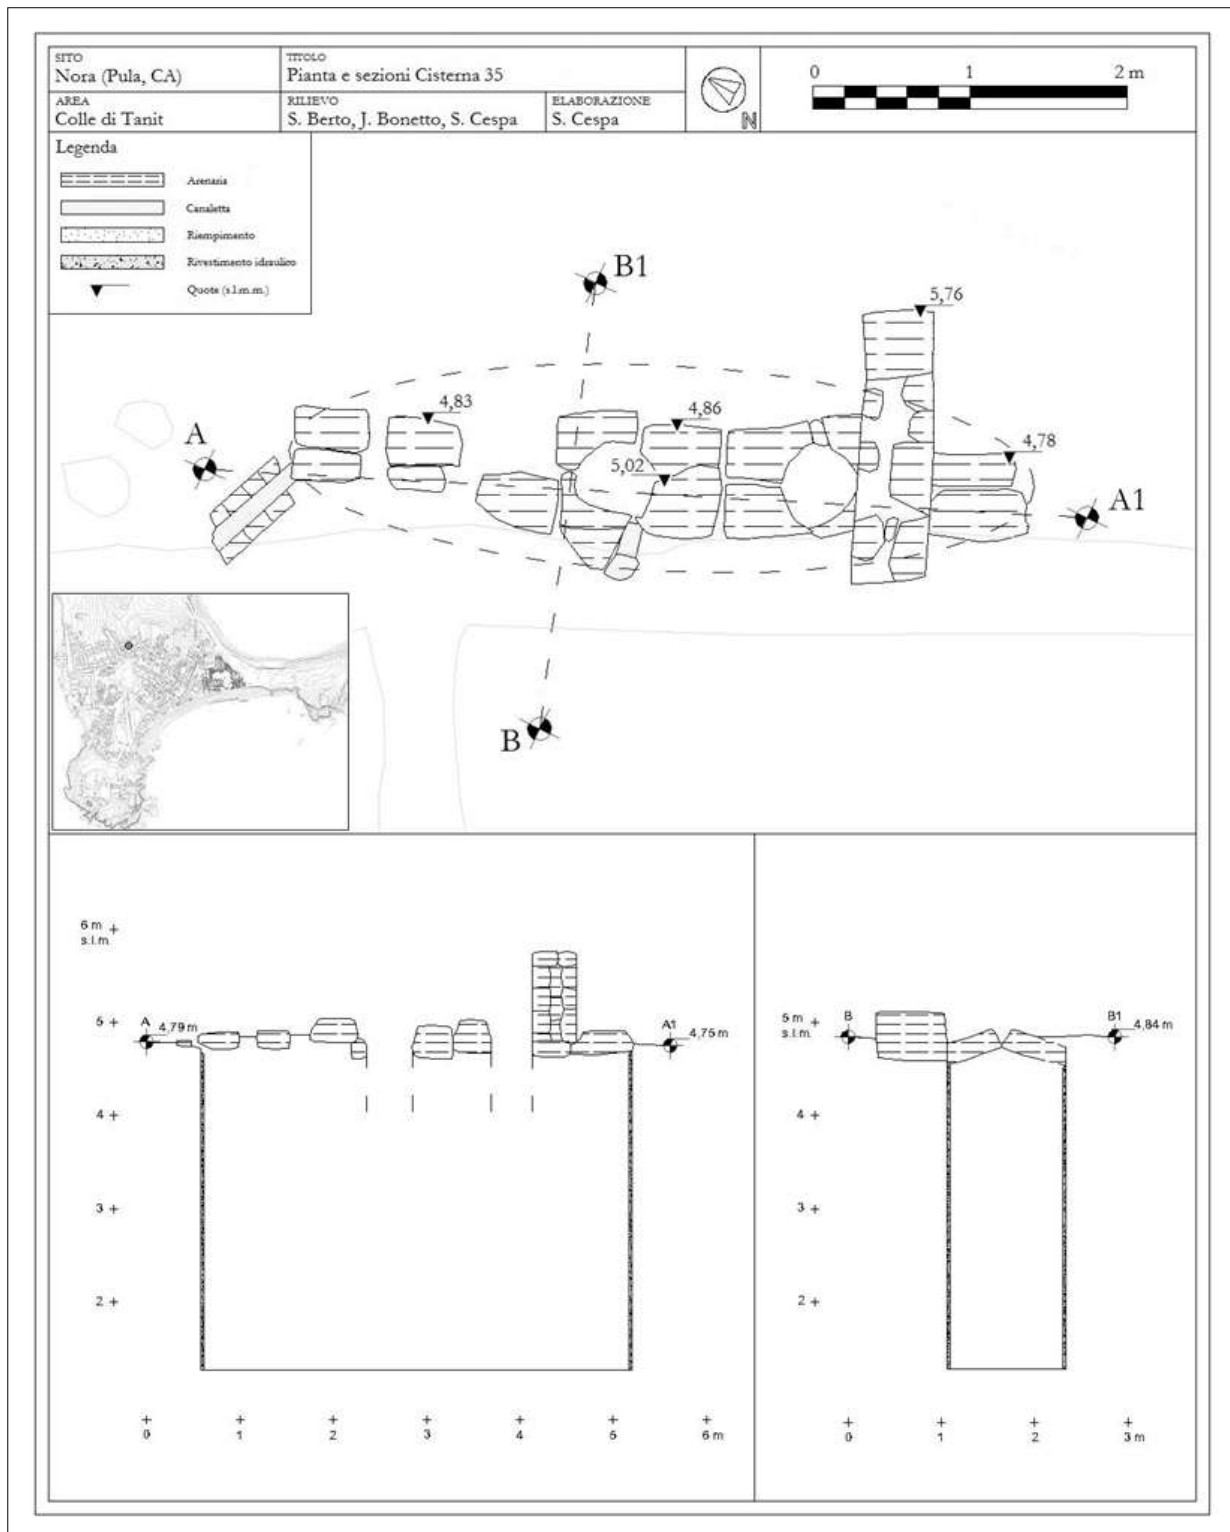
Pianta e sezioni della cisterna 35 (elaborazione dell'autore).
